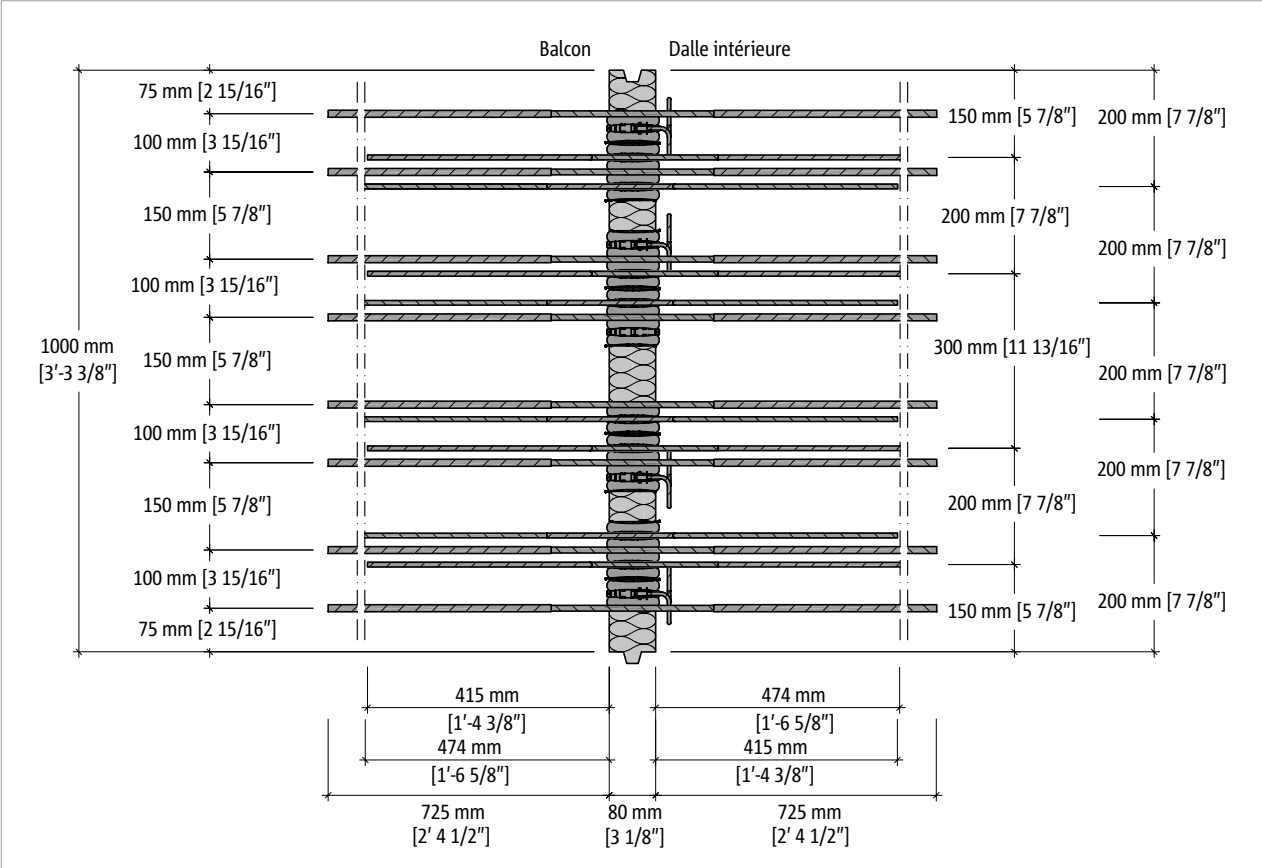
Schöck Isokorb® T Type CK-M6-VV1 : vue en plan du produit
